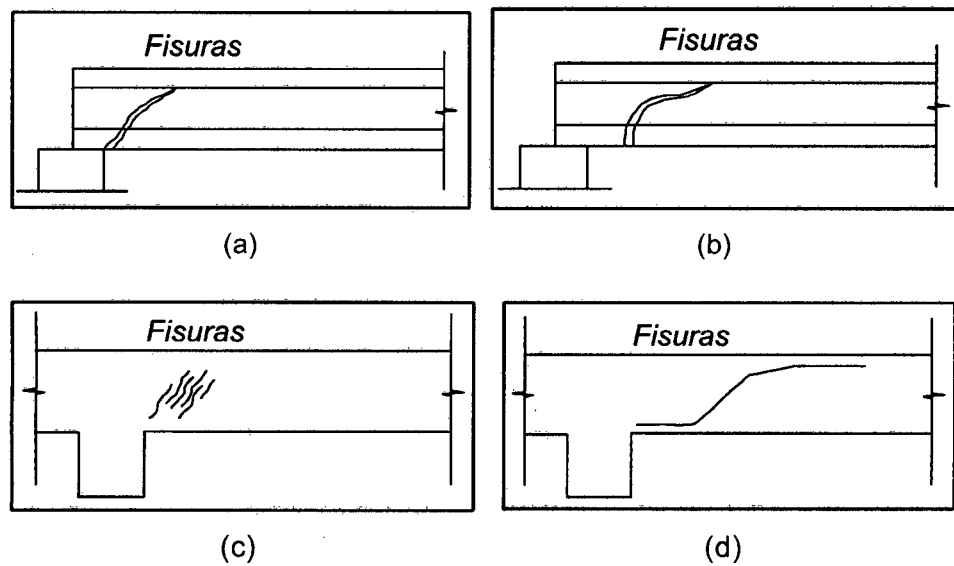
Tipología de las fisuras en vigas debido a esfuerzos de corte (Pérez, 2008).
